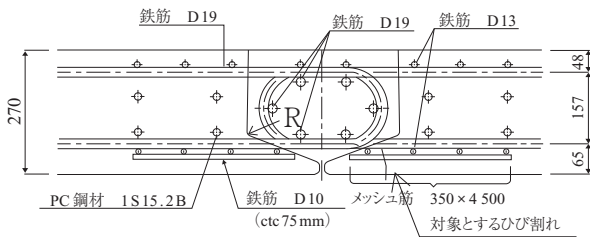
ループ継手とひび割れ補強鉄筋
